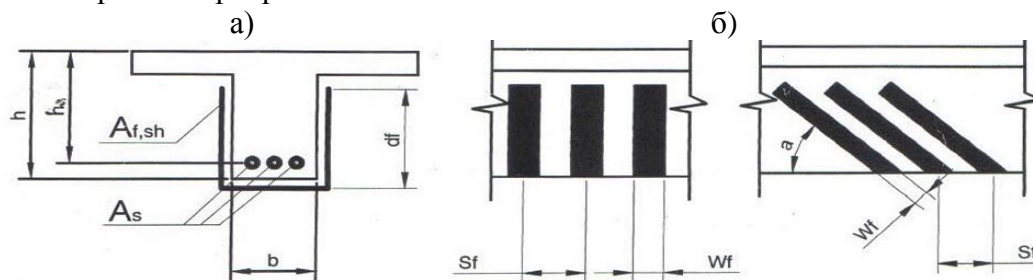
Размещение хомутов из углепластика в приопорных зонах балки для усиления наклонных сечений:
